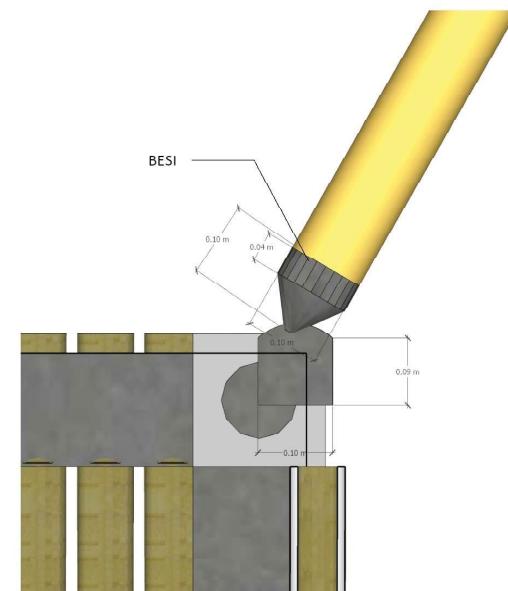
DETAIL SAMBUNGAN ANTARA STRUKTUR BAMBU DAN SHIP CONTAINER
